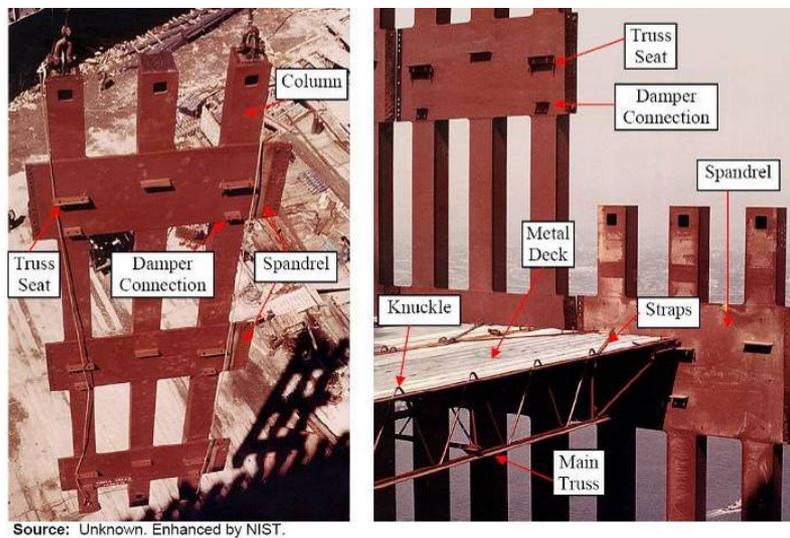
Structure de façade et plancher. Source NIST, Rapport 1, 2005
